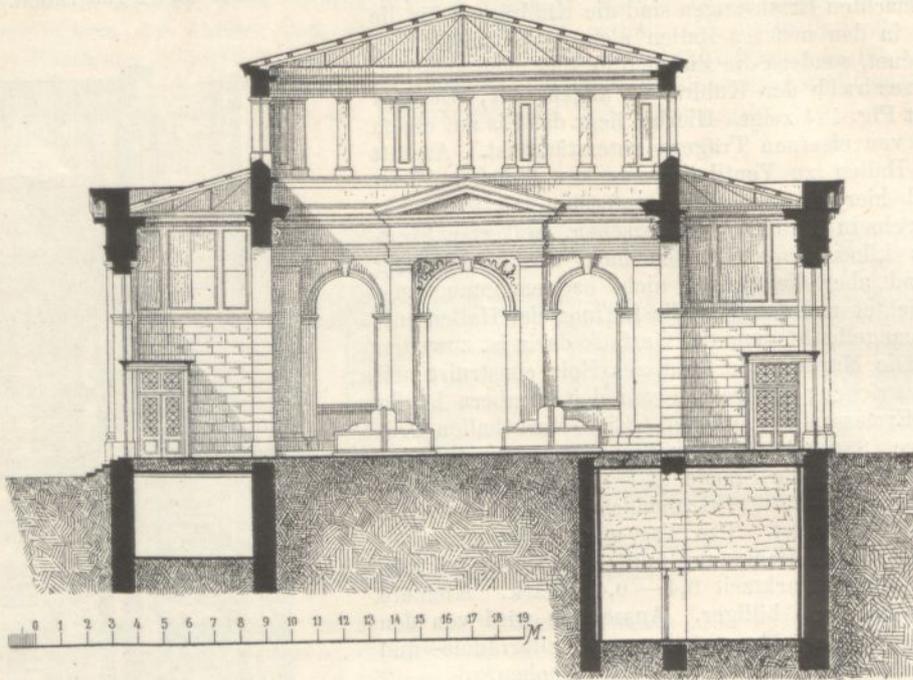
Detail-Markthalle in Wien. Querschnitt.
